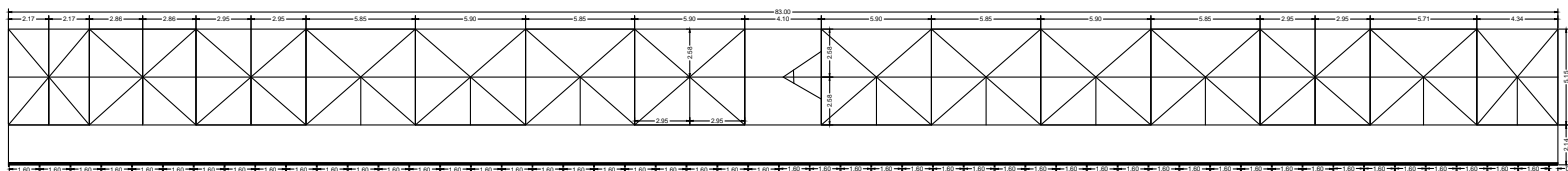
Plano de planta puente Centenario carrera 5 Neiva-Huila.
